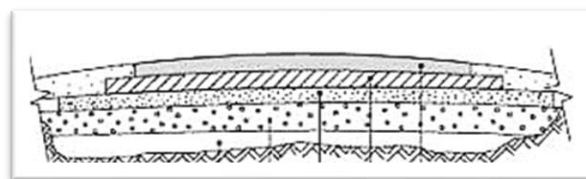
Camadas da Pavimentação Flexível (Asfáltica) – exemplo ilustrativo
